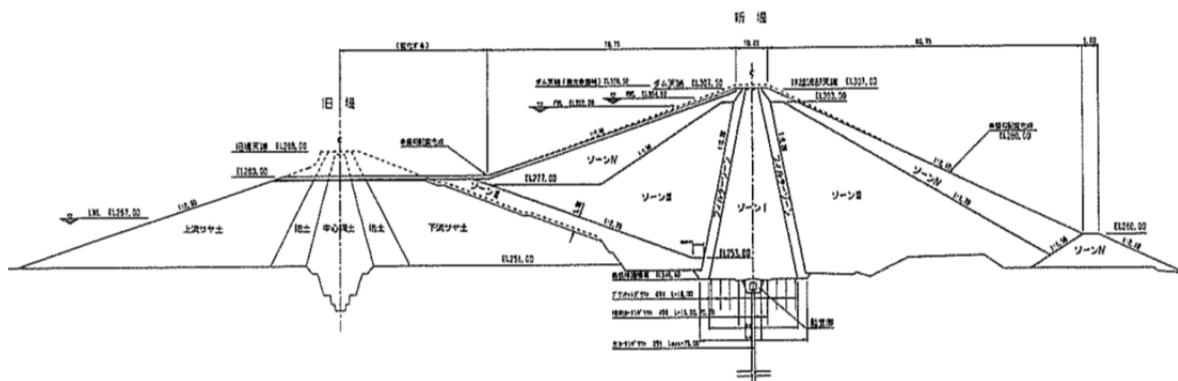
山王海ダム嵩上げ工事標準断面図 2-2)
